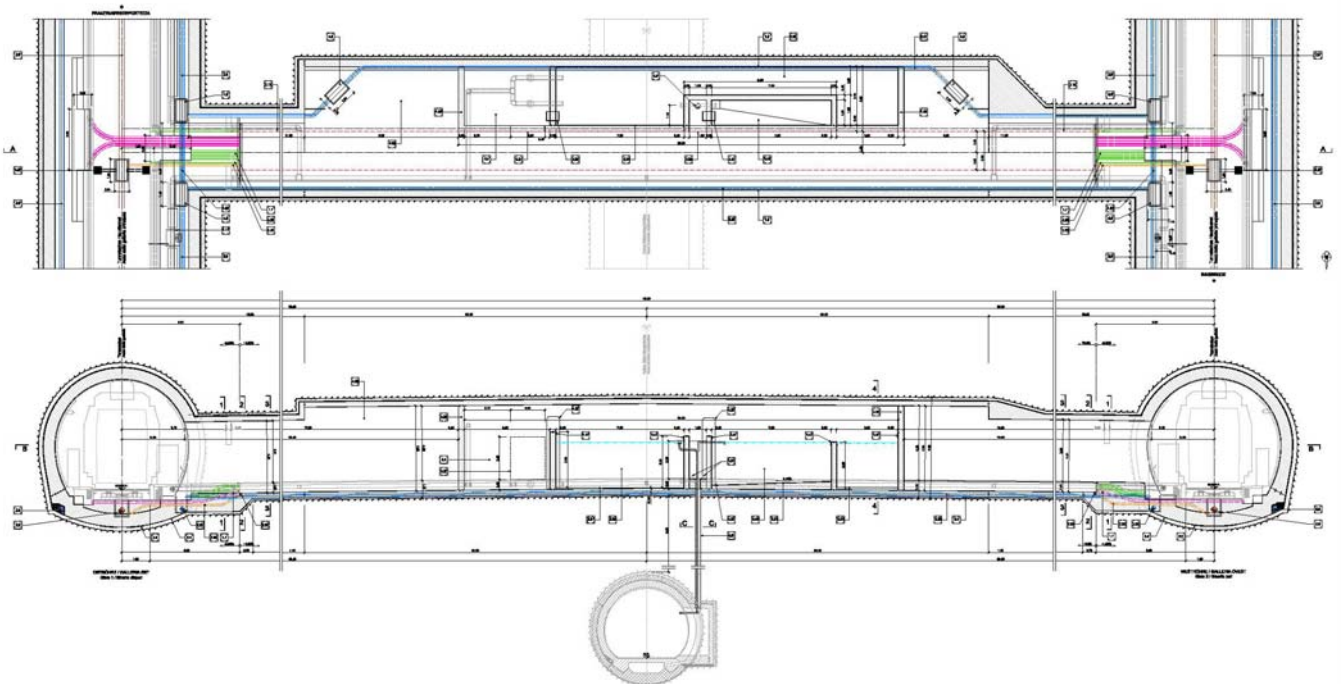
Querschlag Typ 3 (BP 45/3) - Lageplan und Längenschnitt [62]
